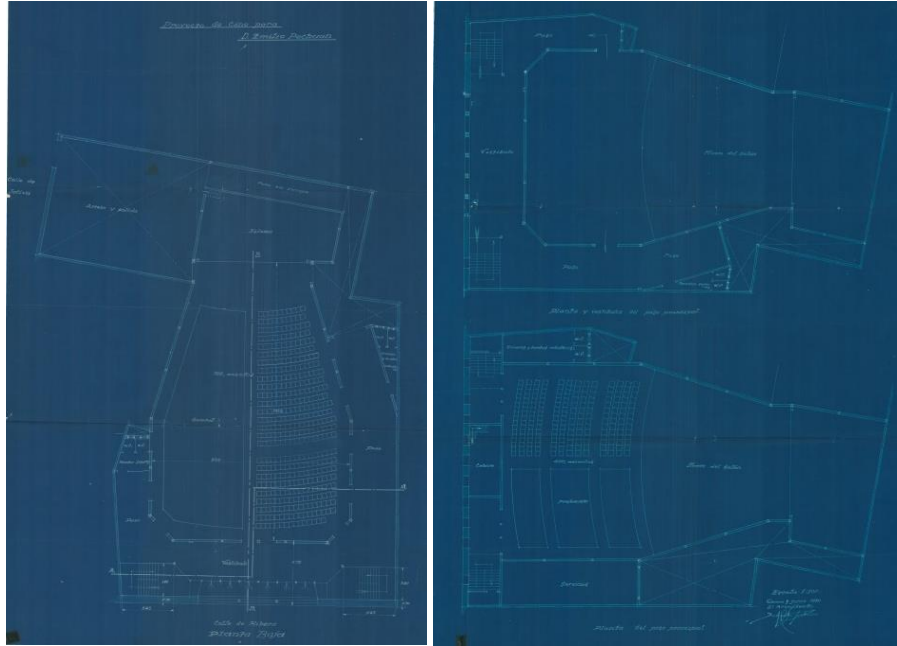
Plano planta baja del proyecto del 9 de junio de 1930. 02 Planos de la 2 y 3 planta del proyecto del 9 de junio de 1930
